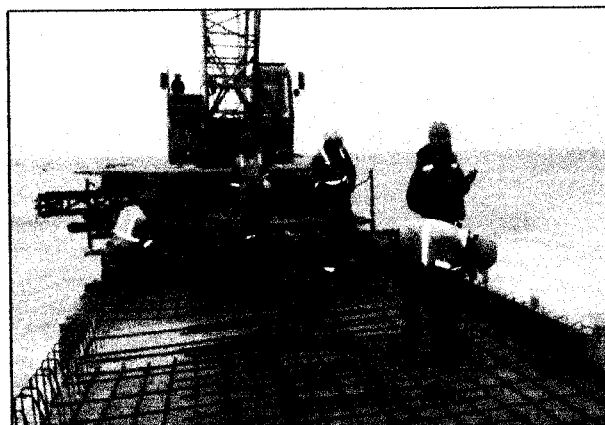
Fundido de juntas longitudinales y transversales.
